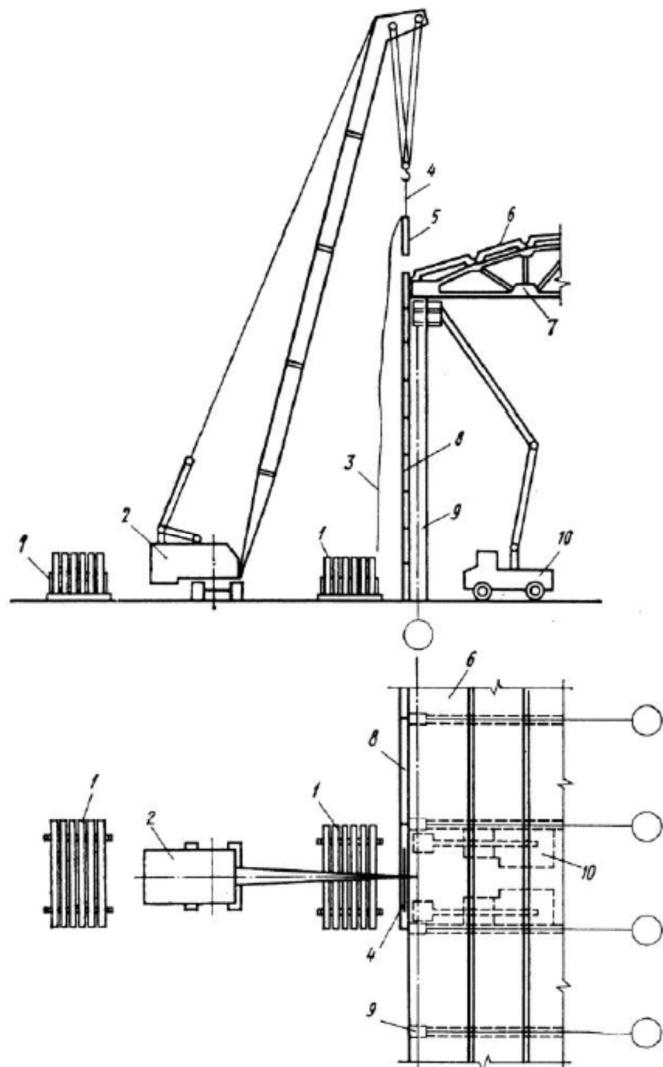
Схема монтажа стеновых ограждающих панелей, кран расположен между двумя кассетами: 1 - кассета; 2 - монтажный кран; 3 - оттяжка из пенькового каната; 4 - двухветвевой строп; 5 - панель стены; 6 - смонтированное покрытие; 7 - стропильная ферма; 8 - стоечное ограждение; 9 - колонна; 10 - монтажный гидроподъемник на автомобиле.
